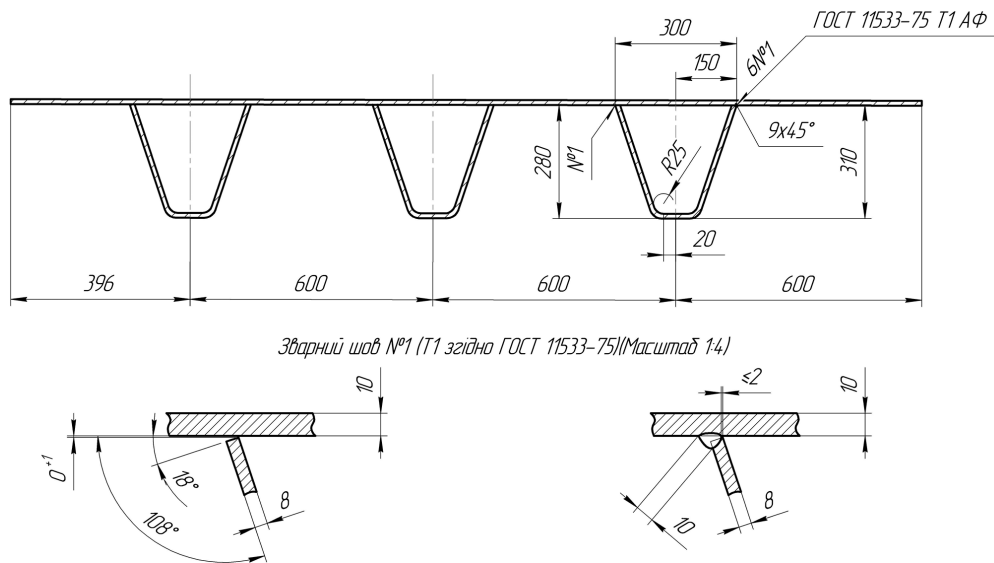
Поперечний переріз зварного вузла плити тротуарної
